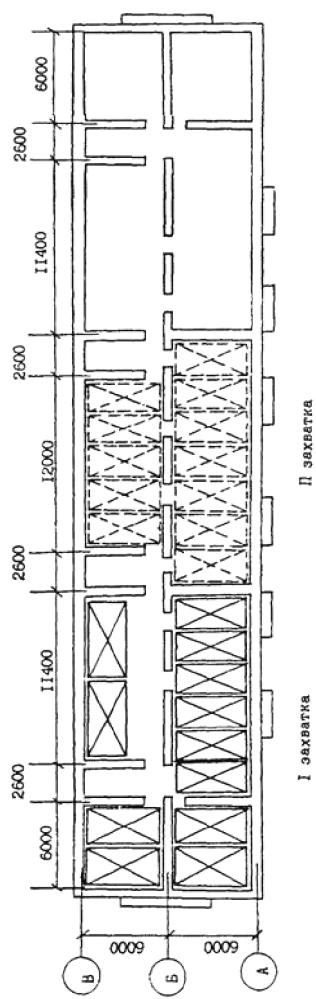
Схема сплошного замазывания подмостей помещениями для кладки стен на захватке
